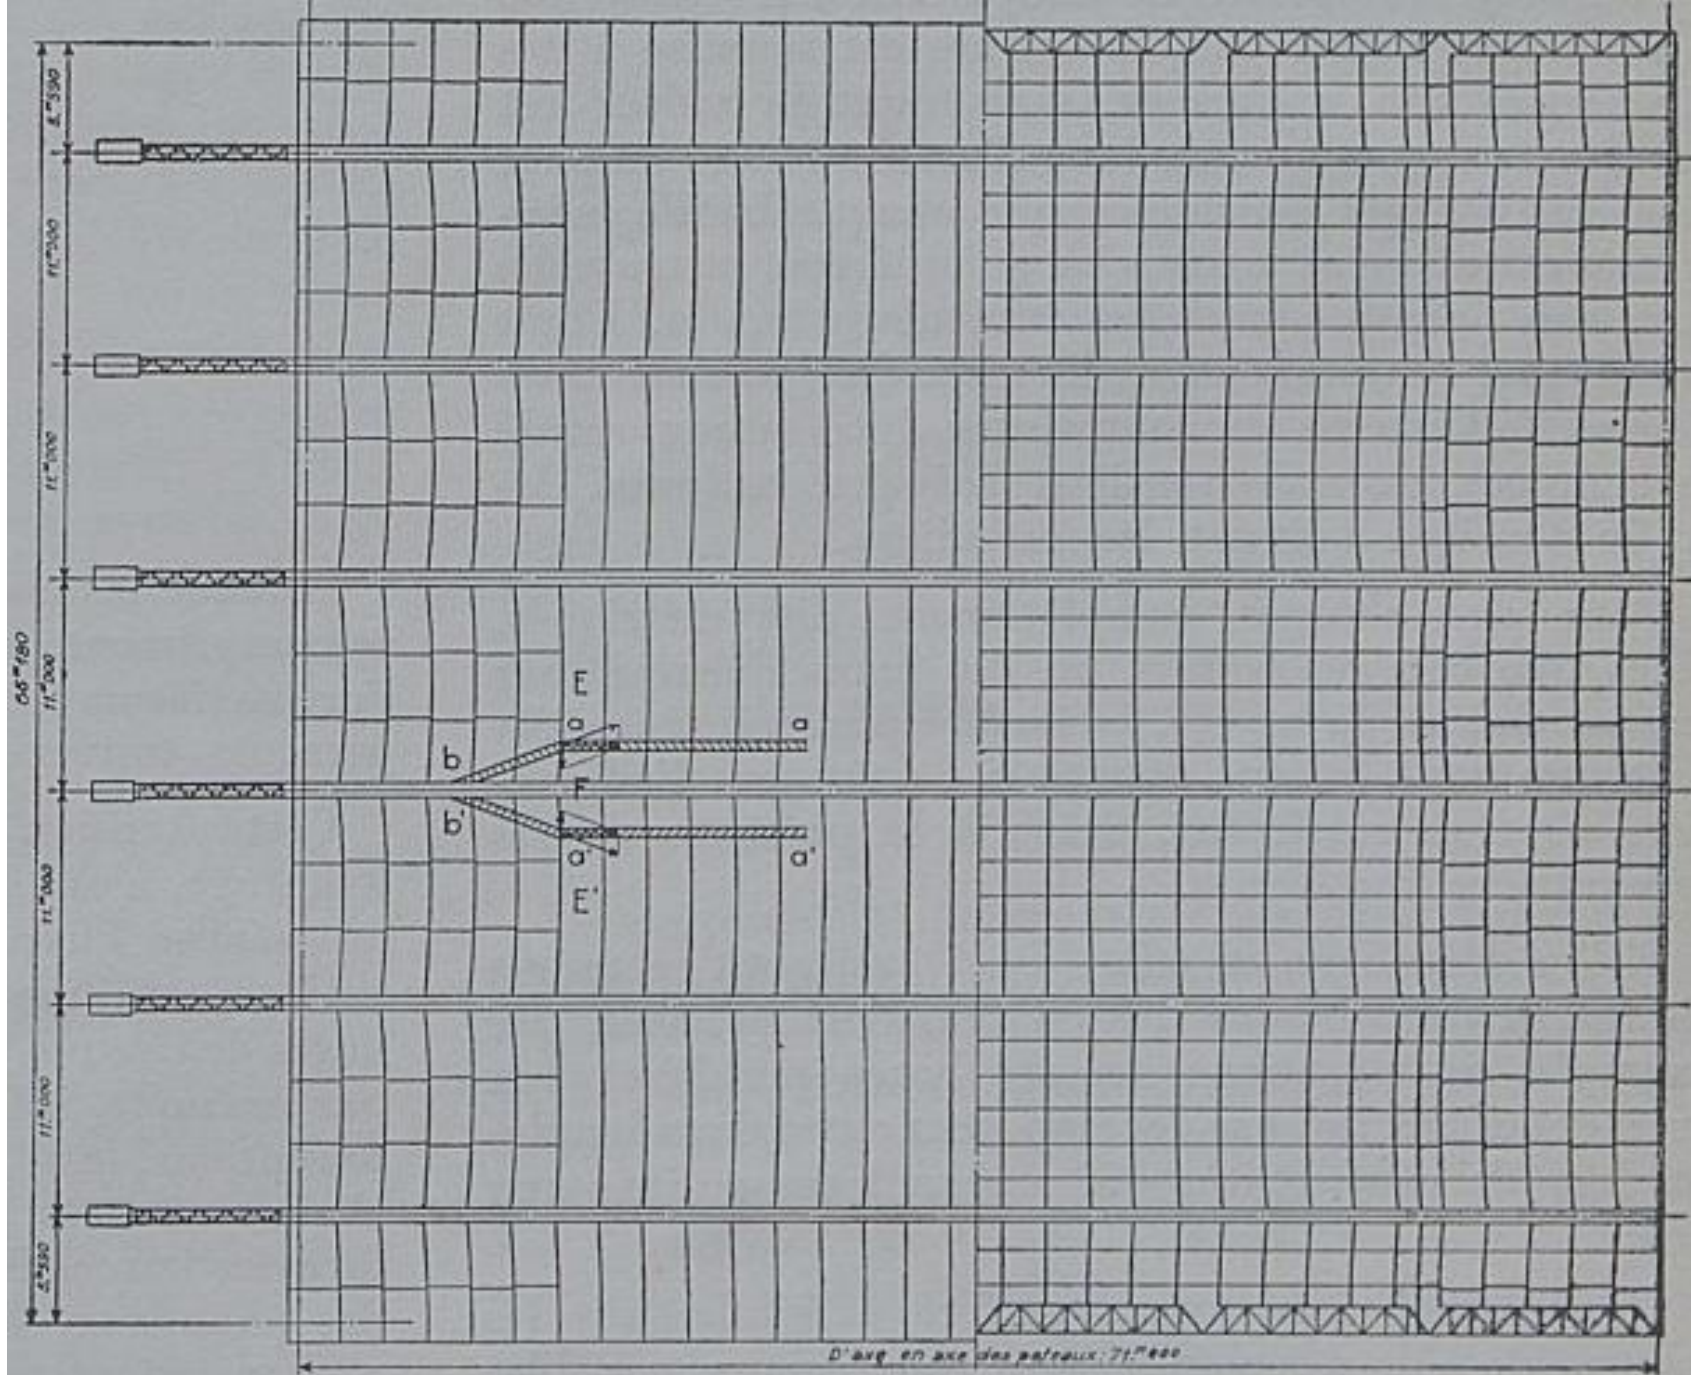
Vues en plan de la toiture et des pannelettes.
